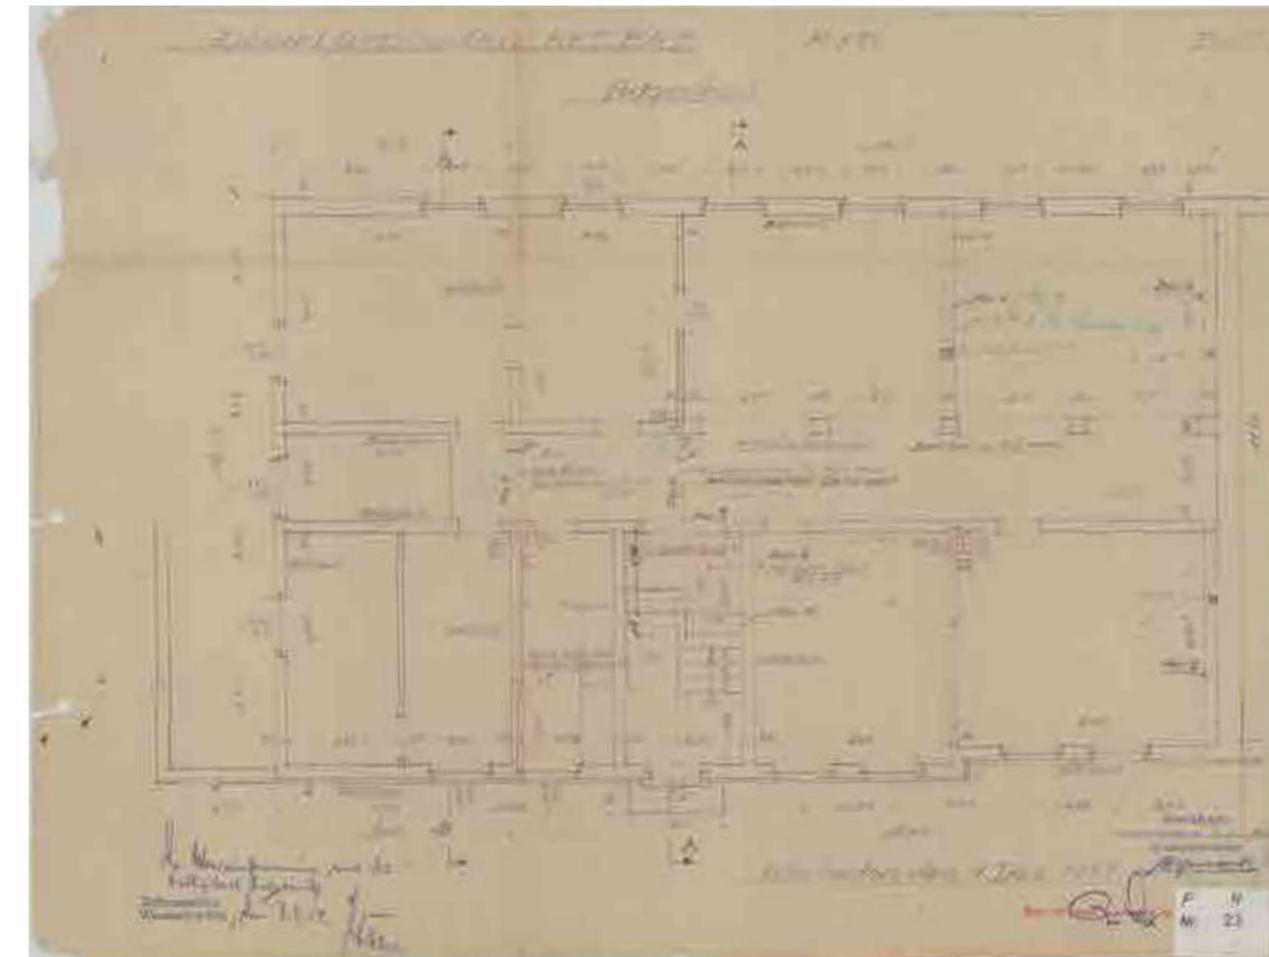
Zollabfertigung: Plan mit Grundriss des Erdgeschosses für den Wiederaufbau, 1951
